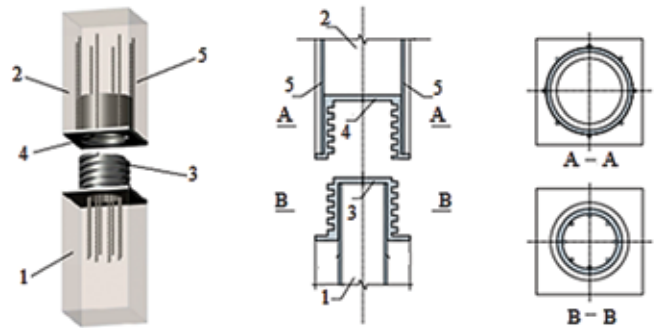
Контактное винтовое соединение сборных железобетонных колонн: 1 – верхняя колонна, 2 – нижняя колонна, 3 – цилиндрическая наружная резьба, 4 – цилиндрическая внутренняя резьба, 5 – продольный рабочий стержень
